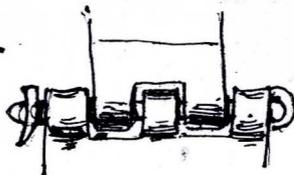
Fig. V. Castello di Gaglianico. Armatura del ponte levatoio.
